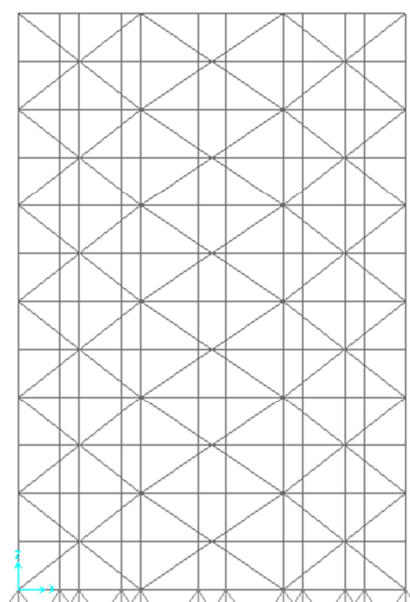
Configuração dos Planos de Contraventamento Vertical Com Elementos de Contraventamento Grandes
